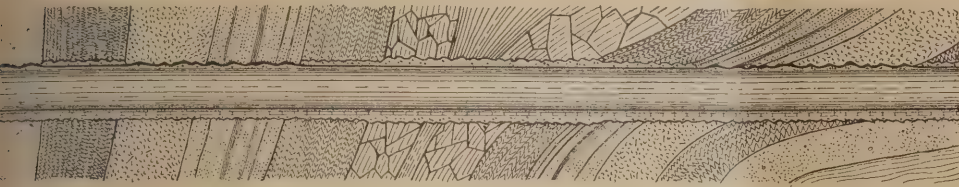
Schema für eine fertig ausgebaute Stollenstrecke.
